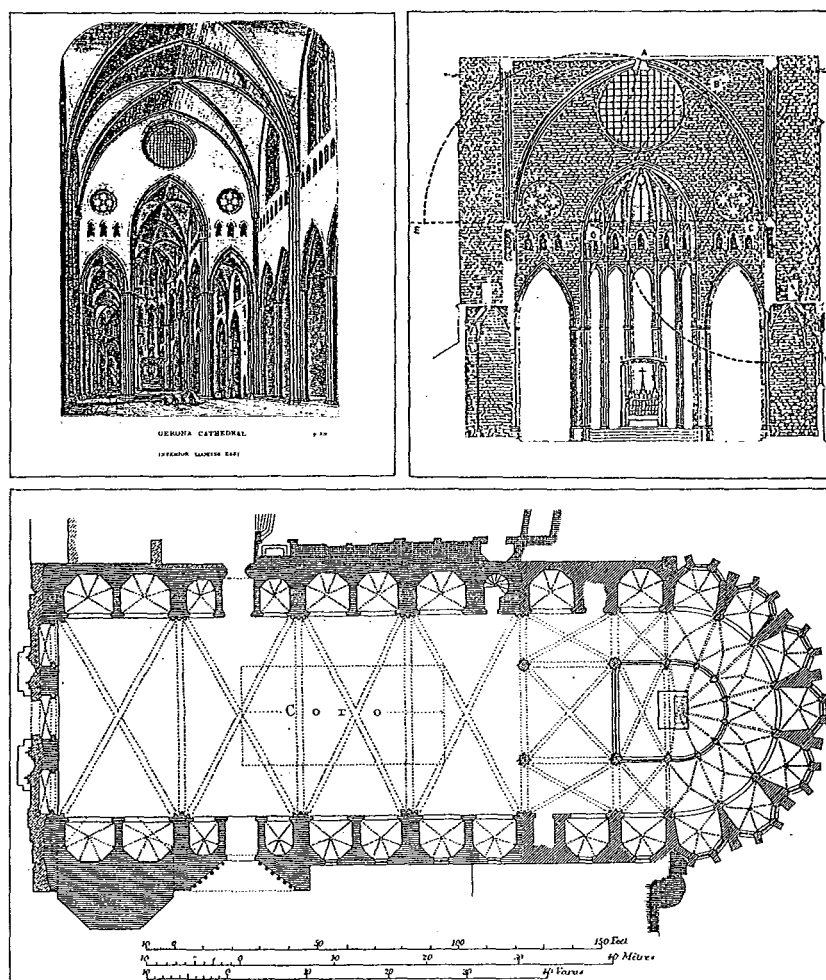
Catedral de Gerona. Planta, sección y vista interior
